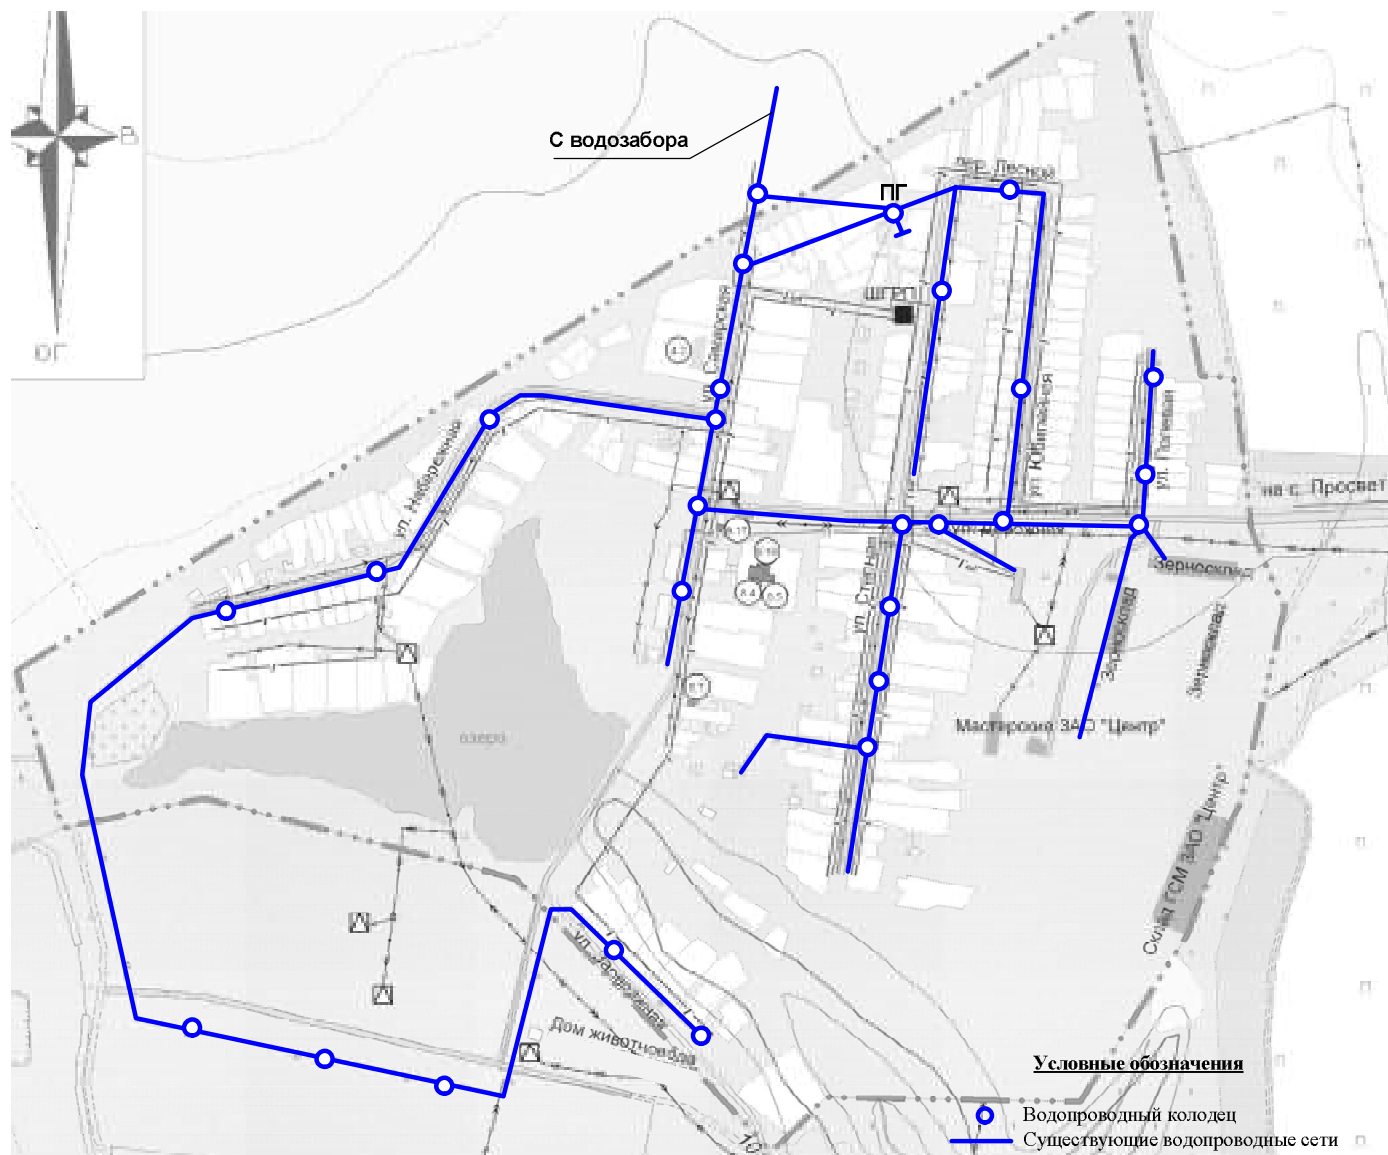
План водопроводных сетей п. Пахарь
